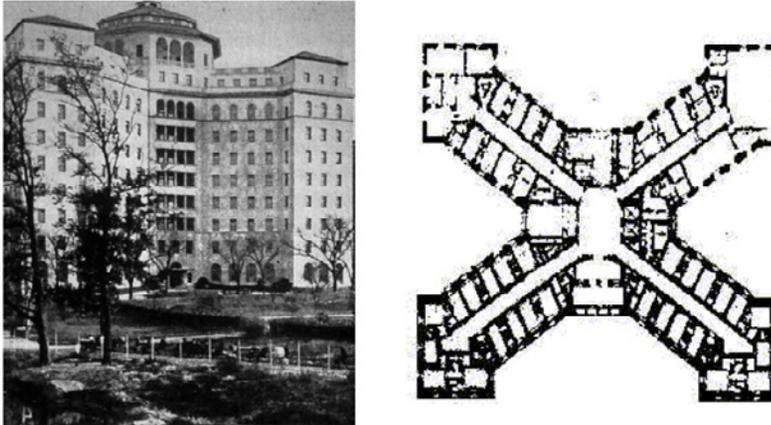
Perspectiva y planta del Hospital de la 5ª avenida de Nueva York (1920)
